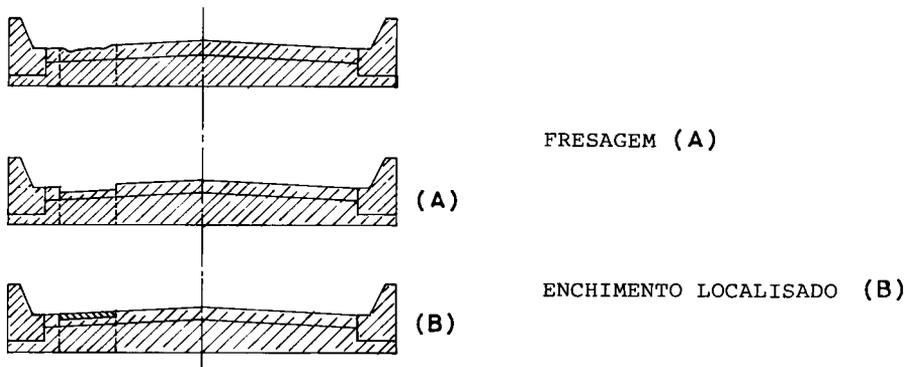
Assentamentos dos pavimentos de trincheiras
